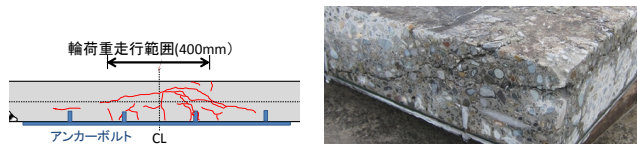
損傷図 (橋軸直角方向) 写真-2 損傷写真
